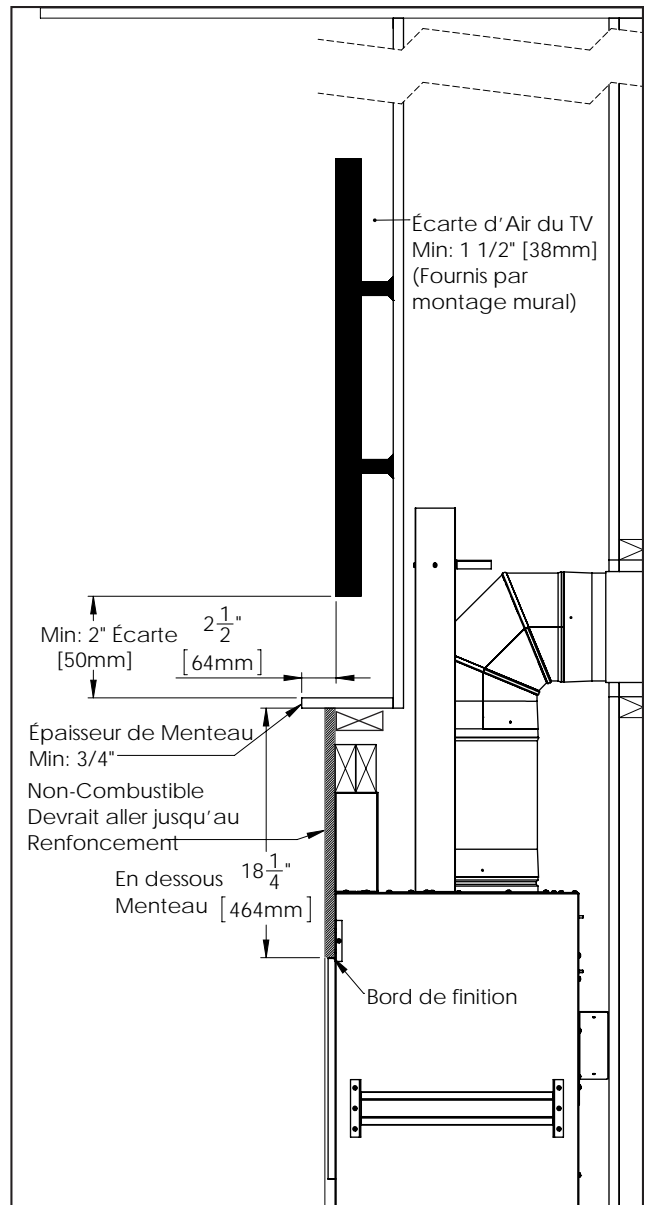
Dégagement minimum d'Installation de TV avec renforcement
